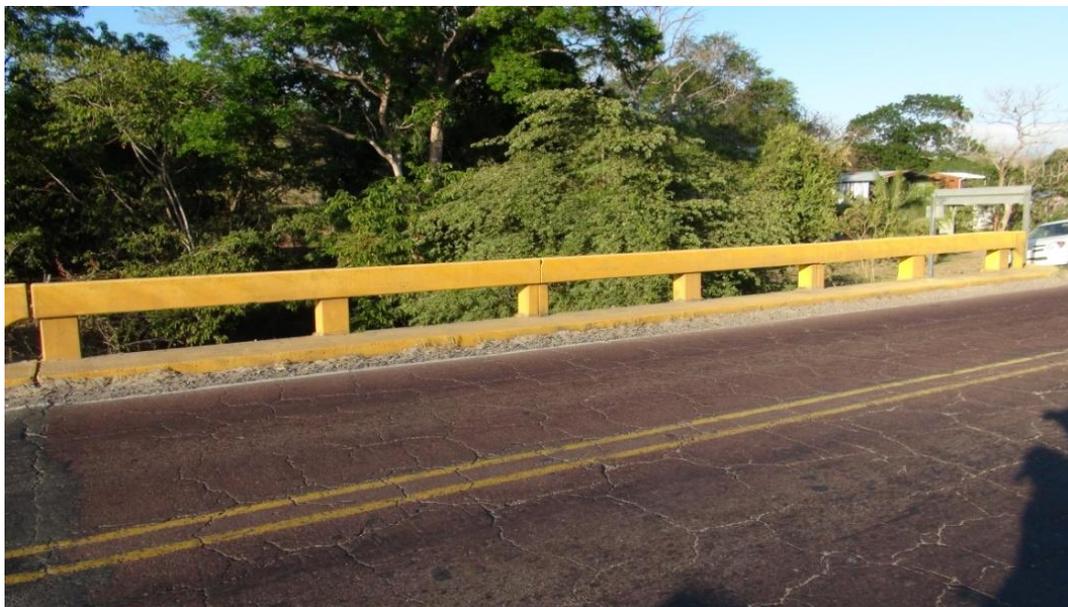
Agrietamiento de la carpeta asfáltica sobre el puente.
